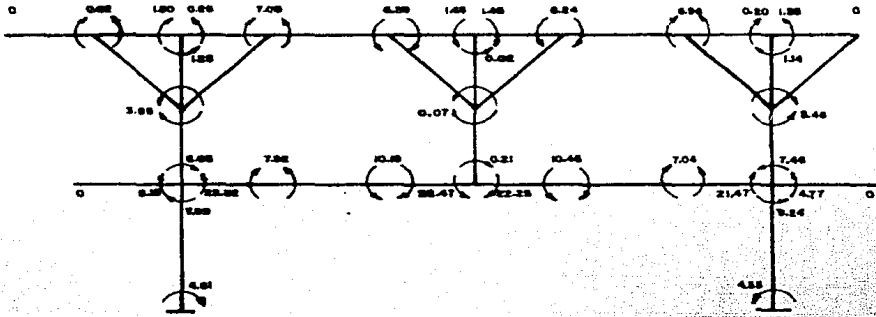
ELEMENTOS . MECANICÓS PARA CARGA VIVA + CARGA MUERTA
